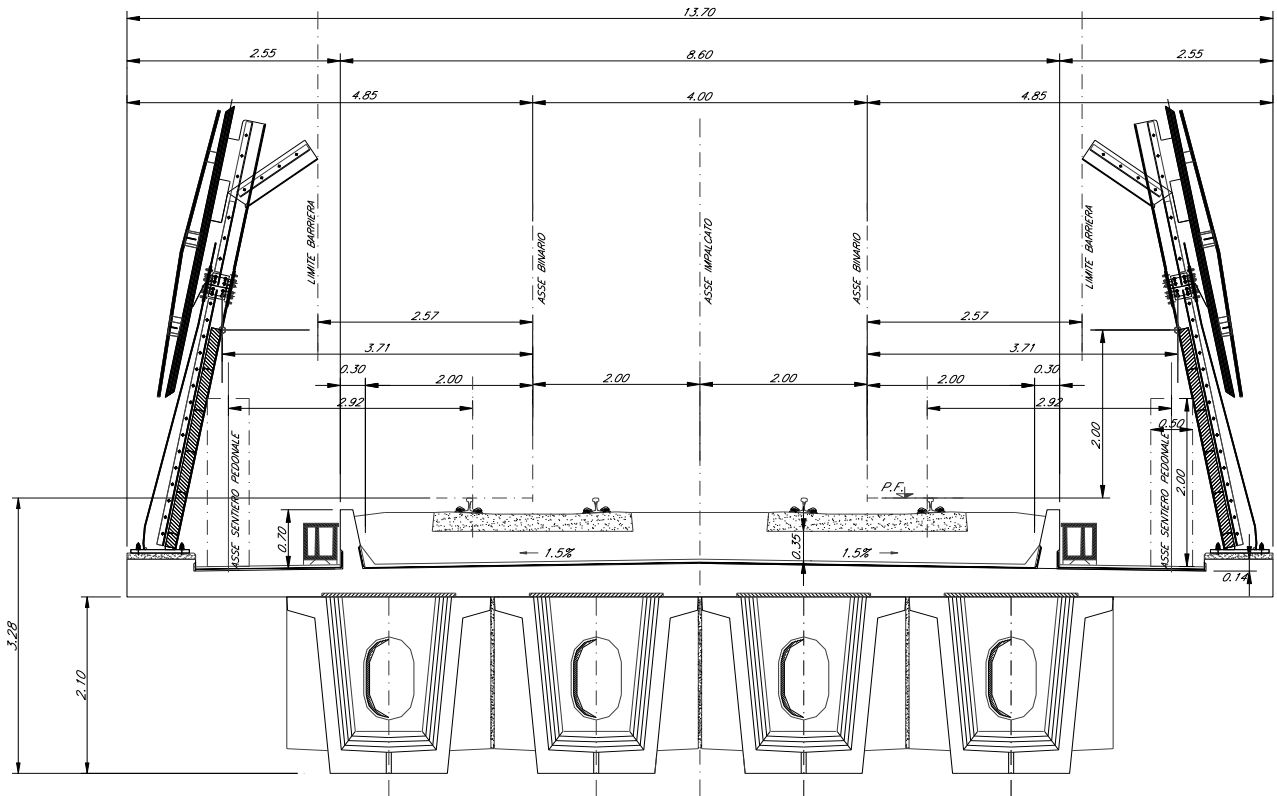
Sezione tipo viadotto c.a.p. L=25.00m
